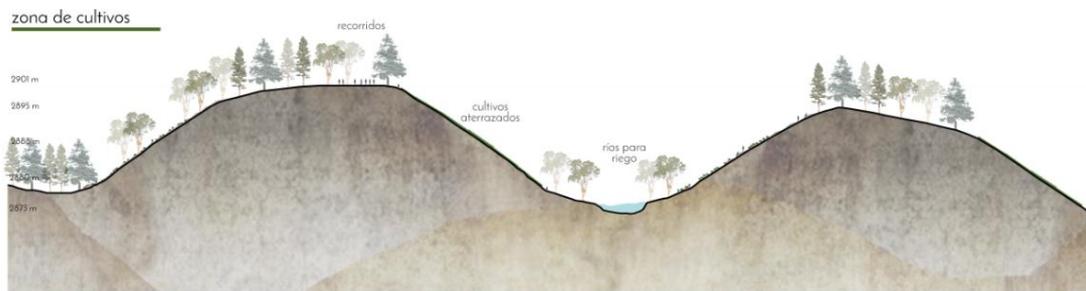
Corte propuesto para zona de cultivos. Elaborado por: Miranda y Bravo, 2017
